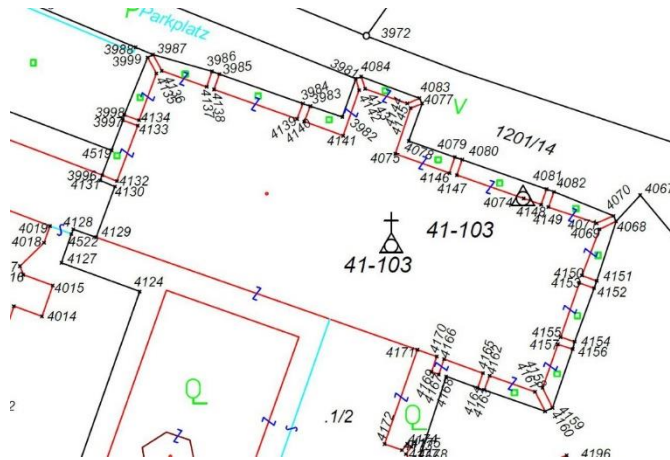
Münster Neuberg, Grundriss Vermessungsamt (Landeskoordinaten GK M34)²⁴
